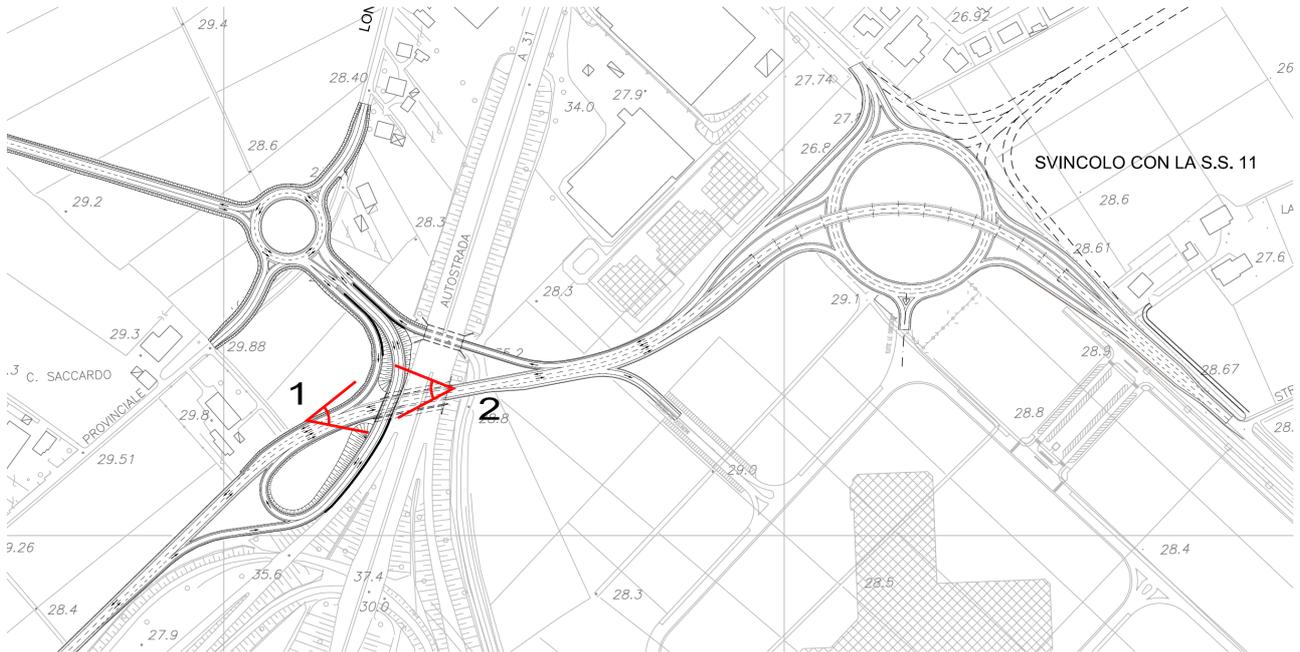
Planimetria con indicazione dei coni visuali del sottopasso
